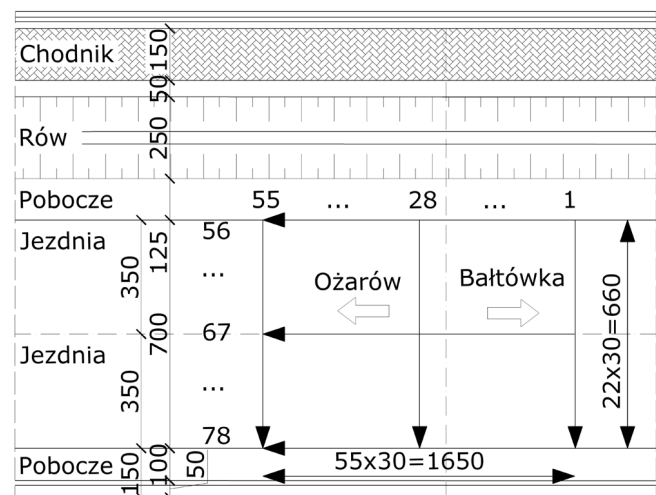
Przekrój poprzeczny przez konstrukcję jezdni nad obiektem
